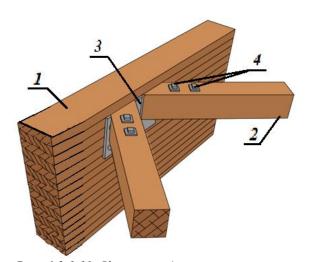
Крепление деревянных раскосов связей с помощью металлических полок 1 - основная несущая конструкция, 2 - брусчатый раскос связевой решетки, 3-стальной сварной башмак с горизонтальными полками, 4 - сквозные болты с квадратными шайбами со стороны древесины
